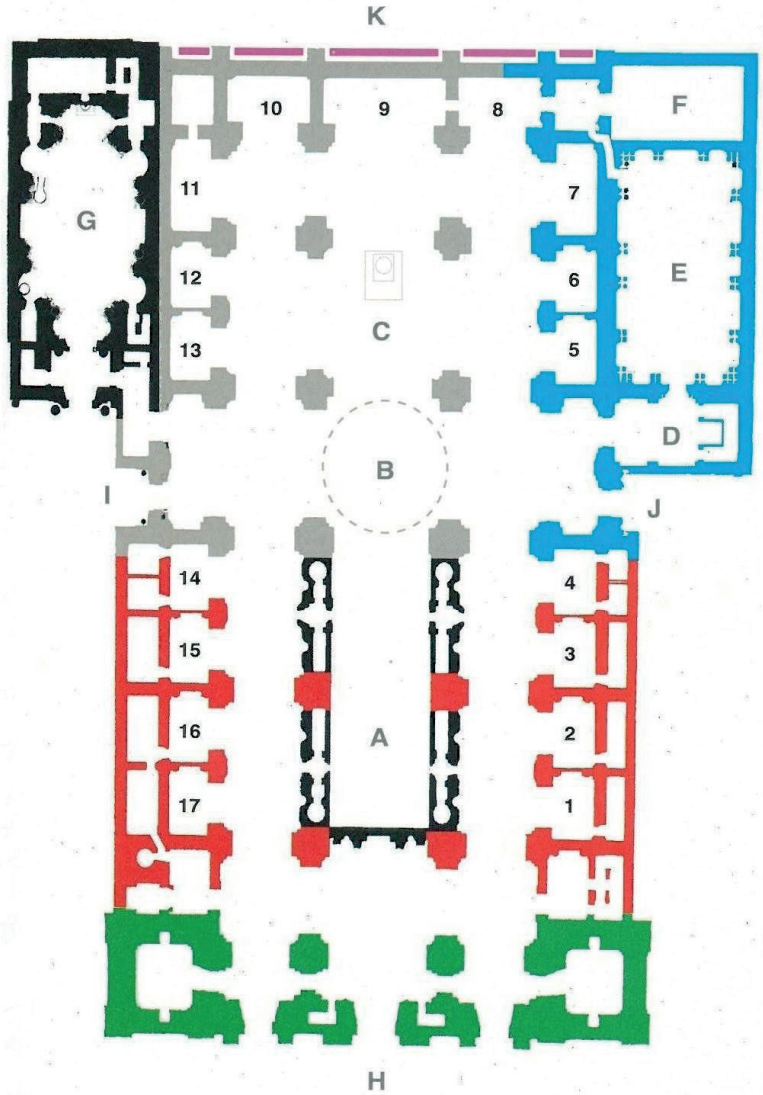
PLANTA ACTUAL DE LA CATEDRAL DE JAÉN
